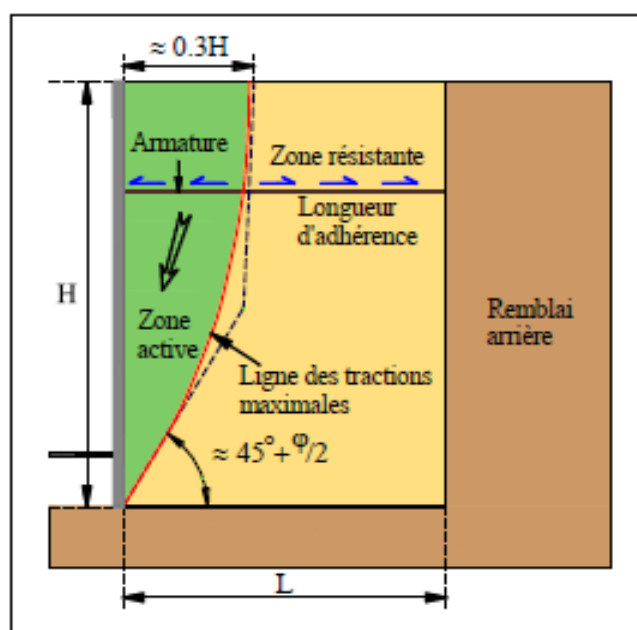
Stabilité interne d'un mur de soutènement en Terre Armée (LCPC, 2003)
